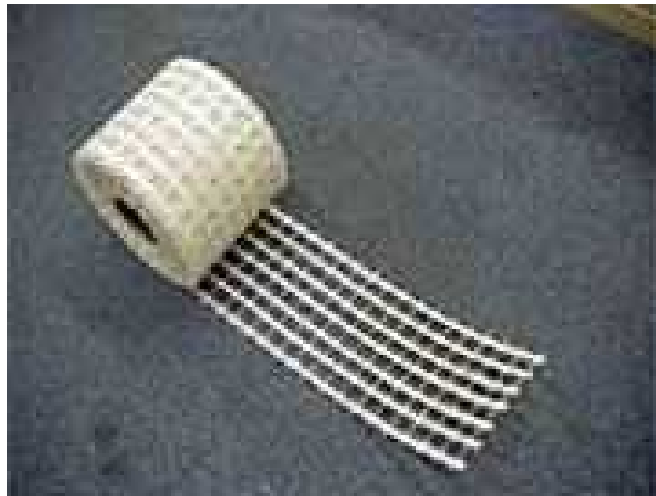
ひび割れ低減用ネットの一例 ³⁵⁾
